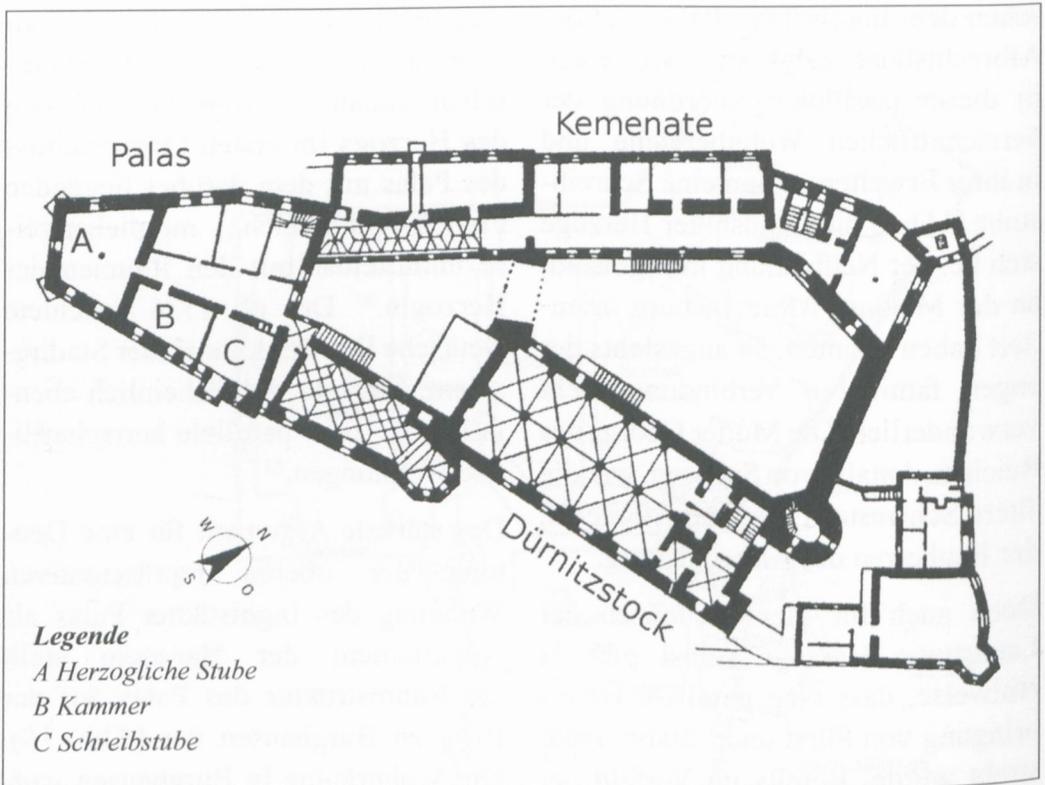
Burghausen, Burg, Grundriss erstes Obergeschoss, Bayerische Schlösserverwaltung, nach Langer 2004, Ergänzungen Christa Syrer
